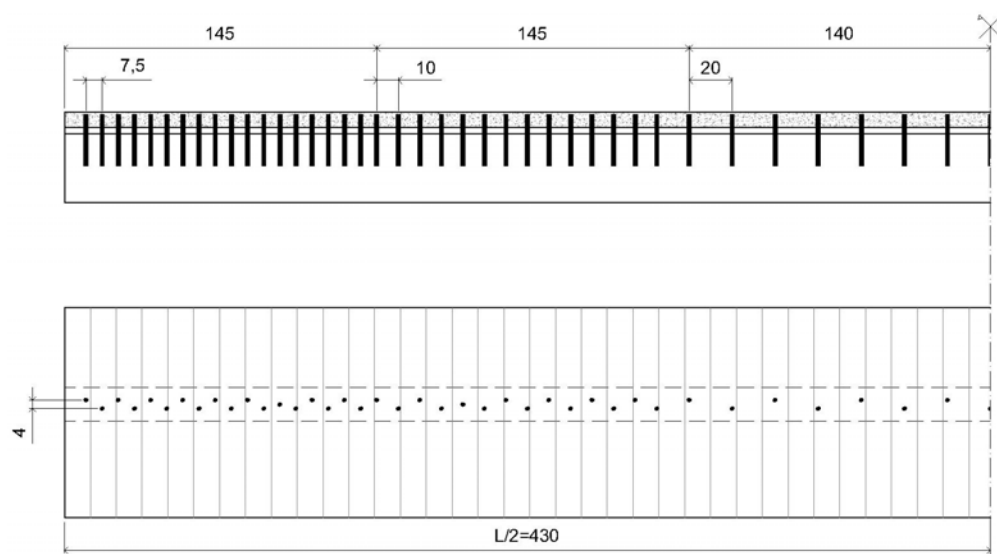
Sezione longitudinale e pianta della trave mista legno-calcestruzzo di cemento
